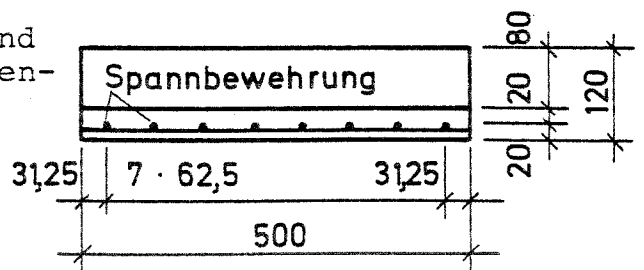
Form, Abmessungen und Bewehrung der Plattenstreifen.
